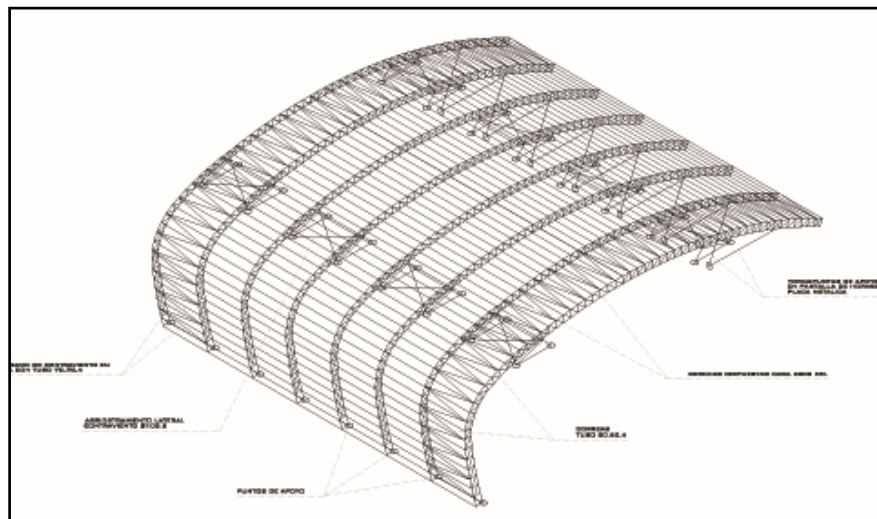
Perspectiva de la cubierta, con la ubicación de las cruces del sistema de arriostramiento.
